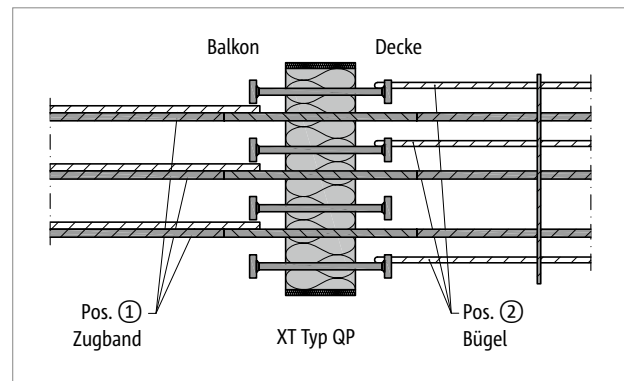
Schöck Isokorb® XT Typ QP: Detail 1; Bewehrungsanschluss Zugband
